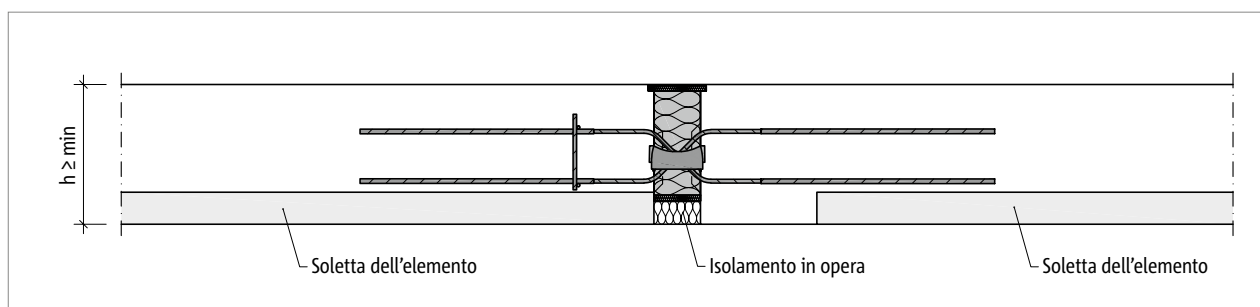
Schöck Isokorb® T tipo QL-VV: solaio prefabbricato con Schöck Isokorb® sovrapposto
